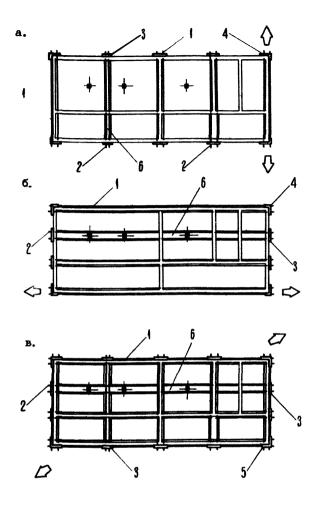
Схемы усиления докольных (фундаментных) поисов здания и устройства железобетонных связей-распорок между стенами с большим свободным пролетом:
